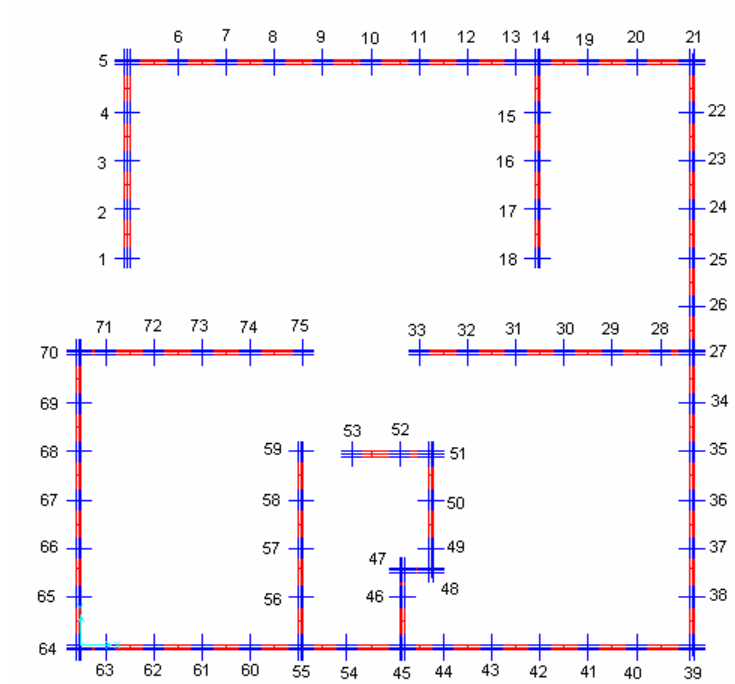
Distribución de los apoyos de los muros MONOWALL en la base del modelo. Vista en el plano XY
